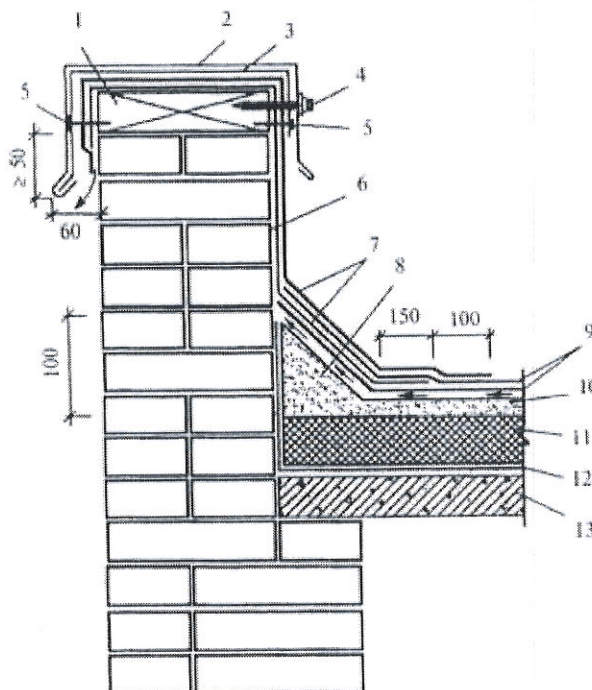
Примыкание водоизоляционного ковра к парапетной стене высотой менее 450 мм:
